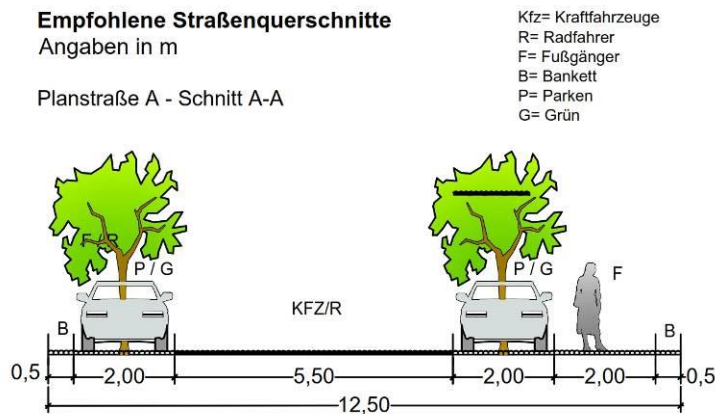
Empfohlener Straßenquerschnitt der Planstraße A.
